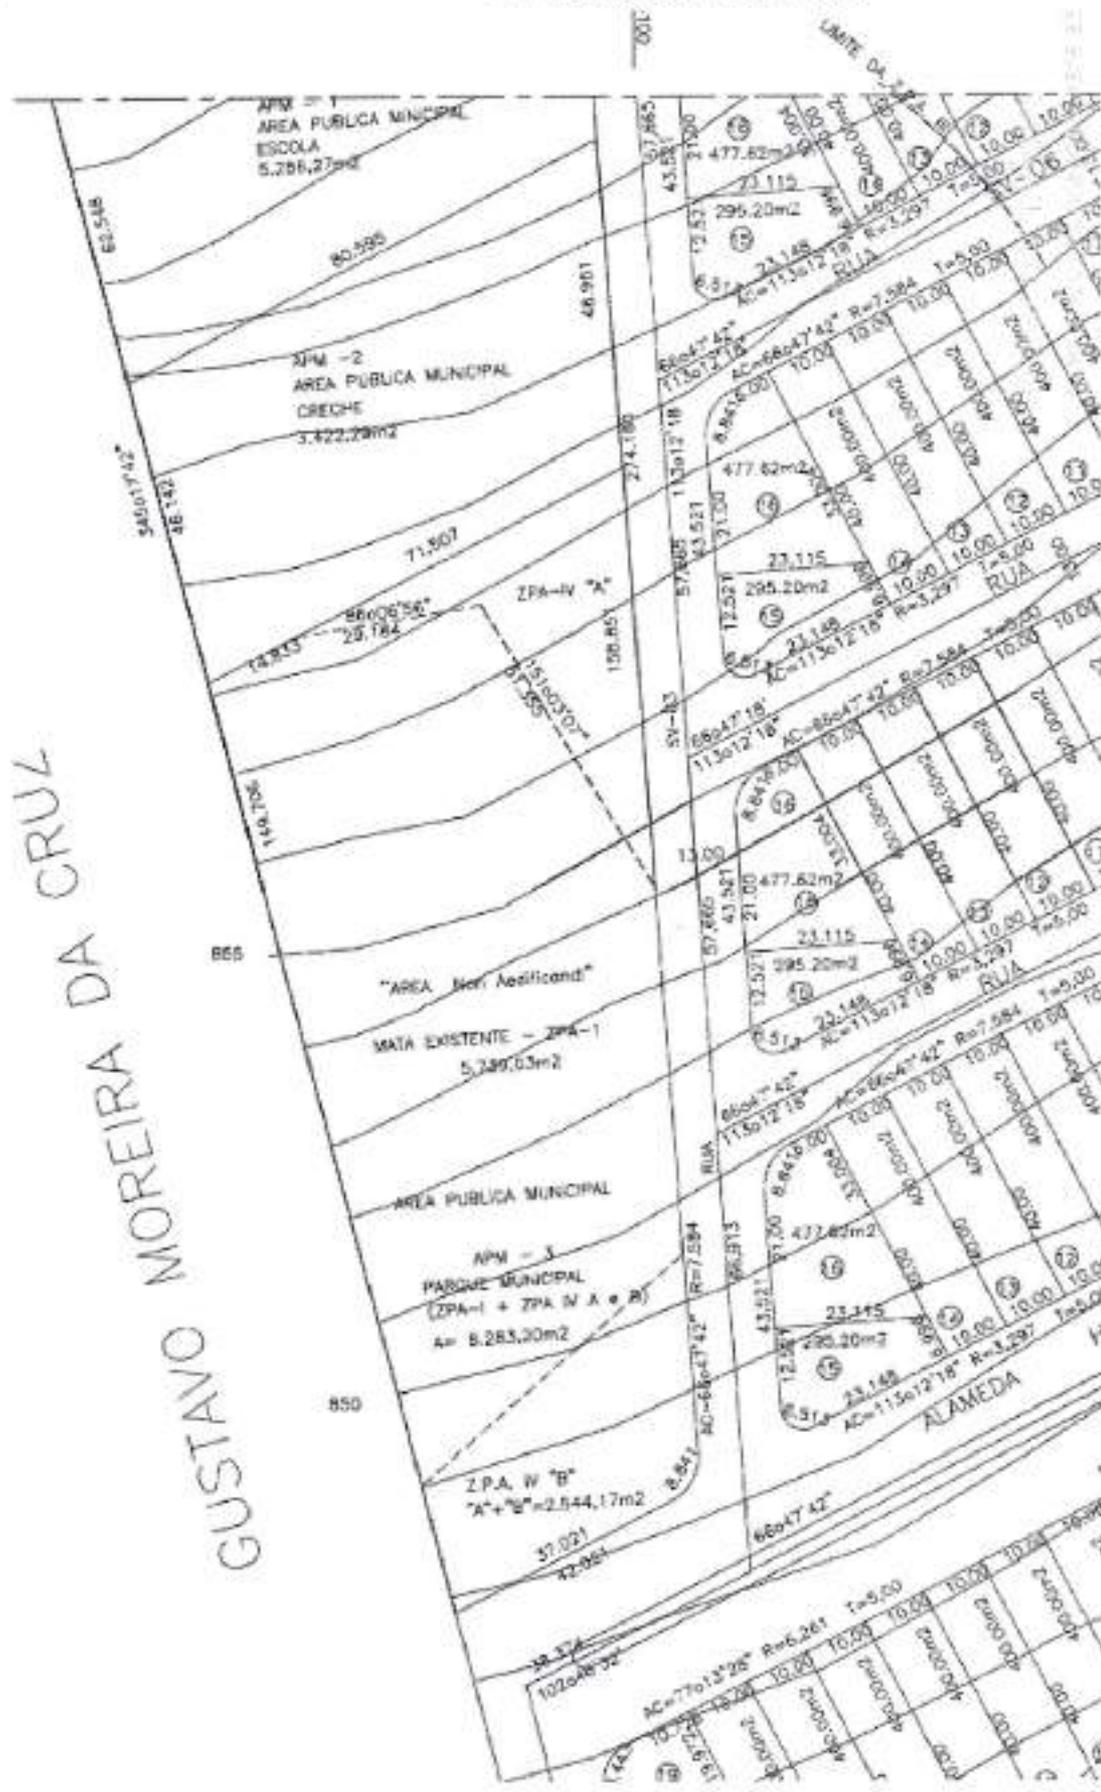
Planta Urbanistica parcial do Res. Solar Ville, indicando a localização da APM 3 Fonte: SIGGO.
